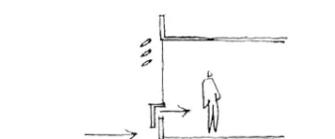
Croqui do Roteiro para se Construir o Nordeste. 1976
